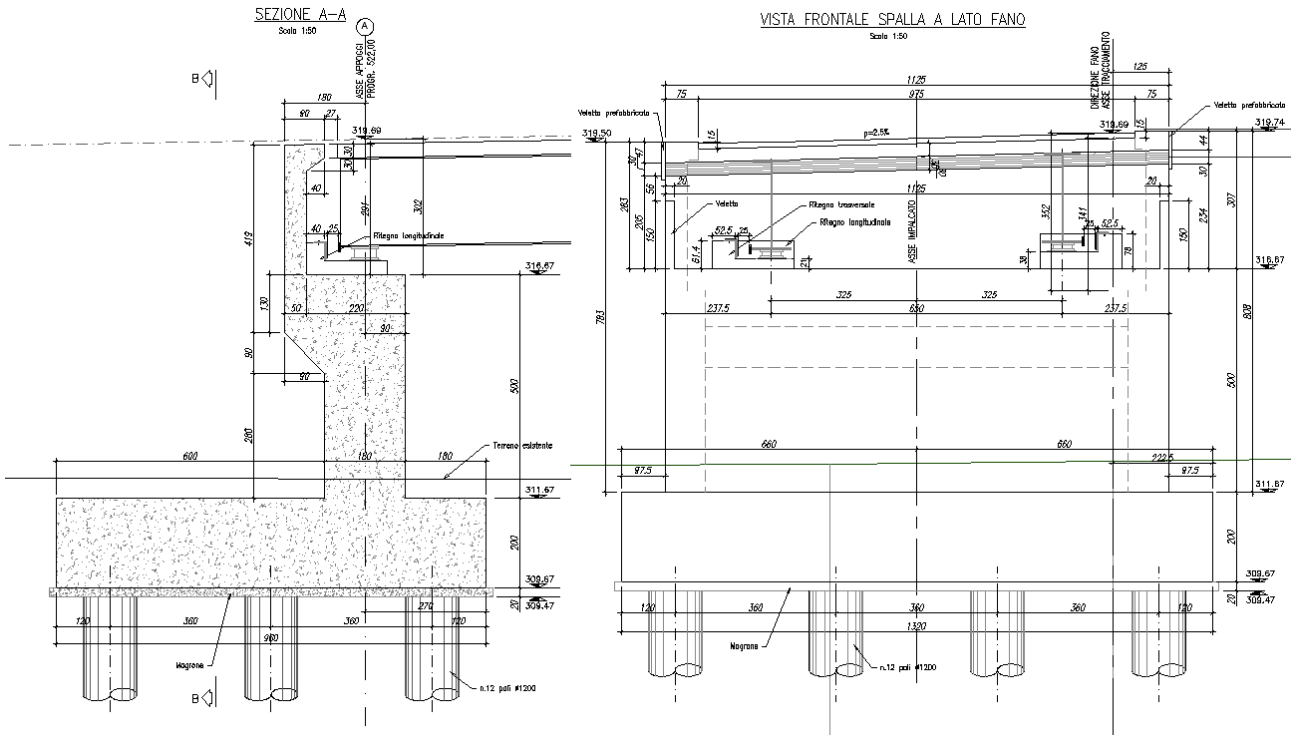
Spalla A (Sezione e prospetto).
